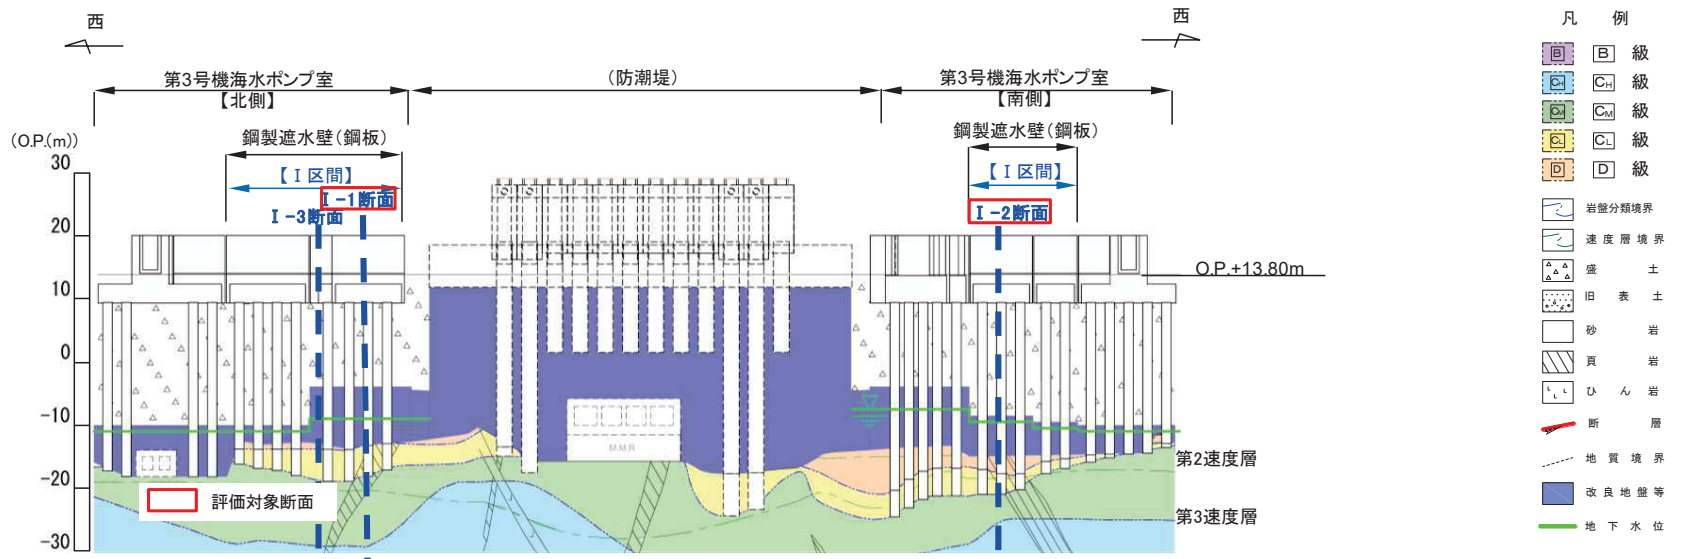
(3) 評価対象断面の地質縦断図 (第3号機海水ポンプ室)
